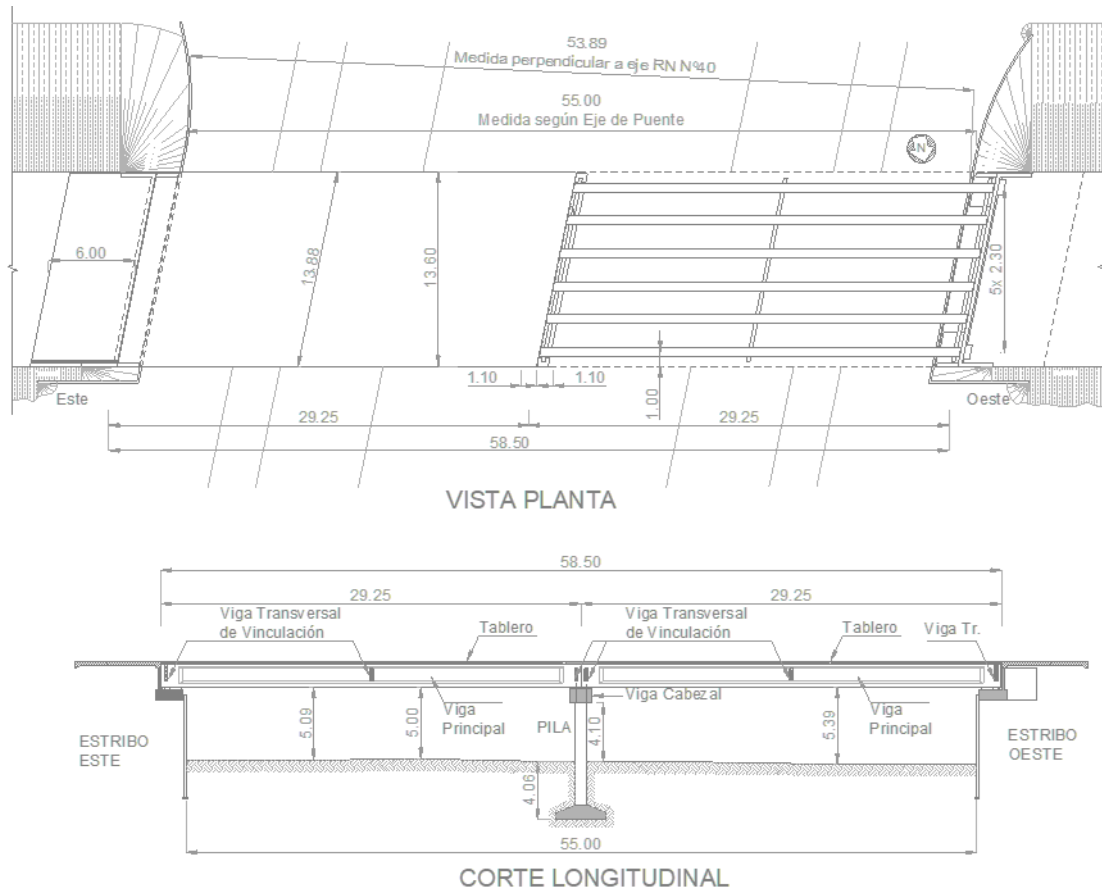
Geometría del puente de calle Paso. Vista en planta y corte longitudinal. Dimensiones en metros.
